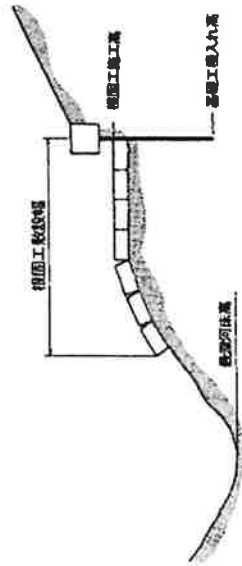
最深河床高、基礎工投入高さ、根固工施工高等の定義
